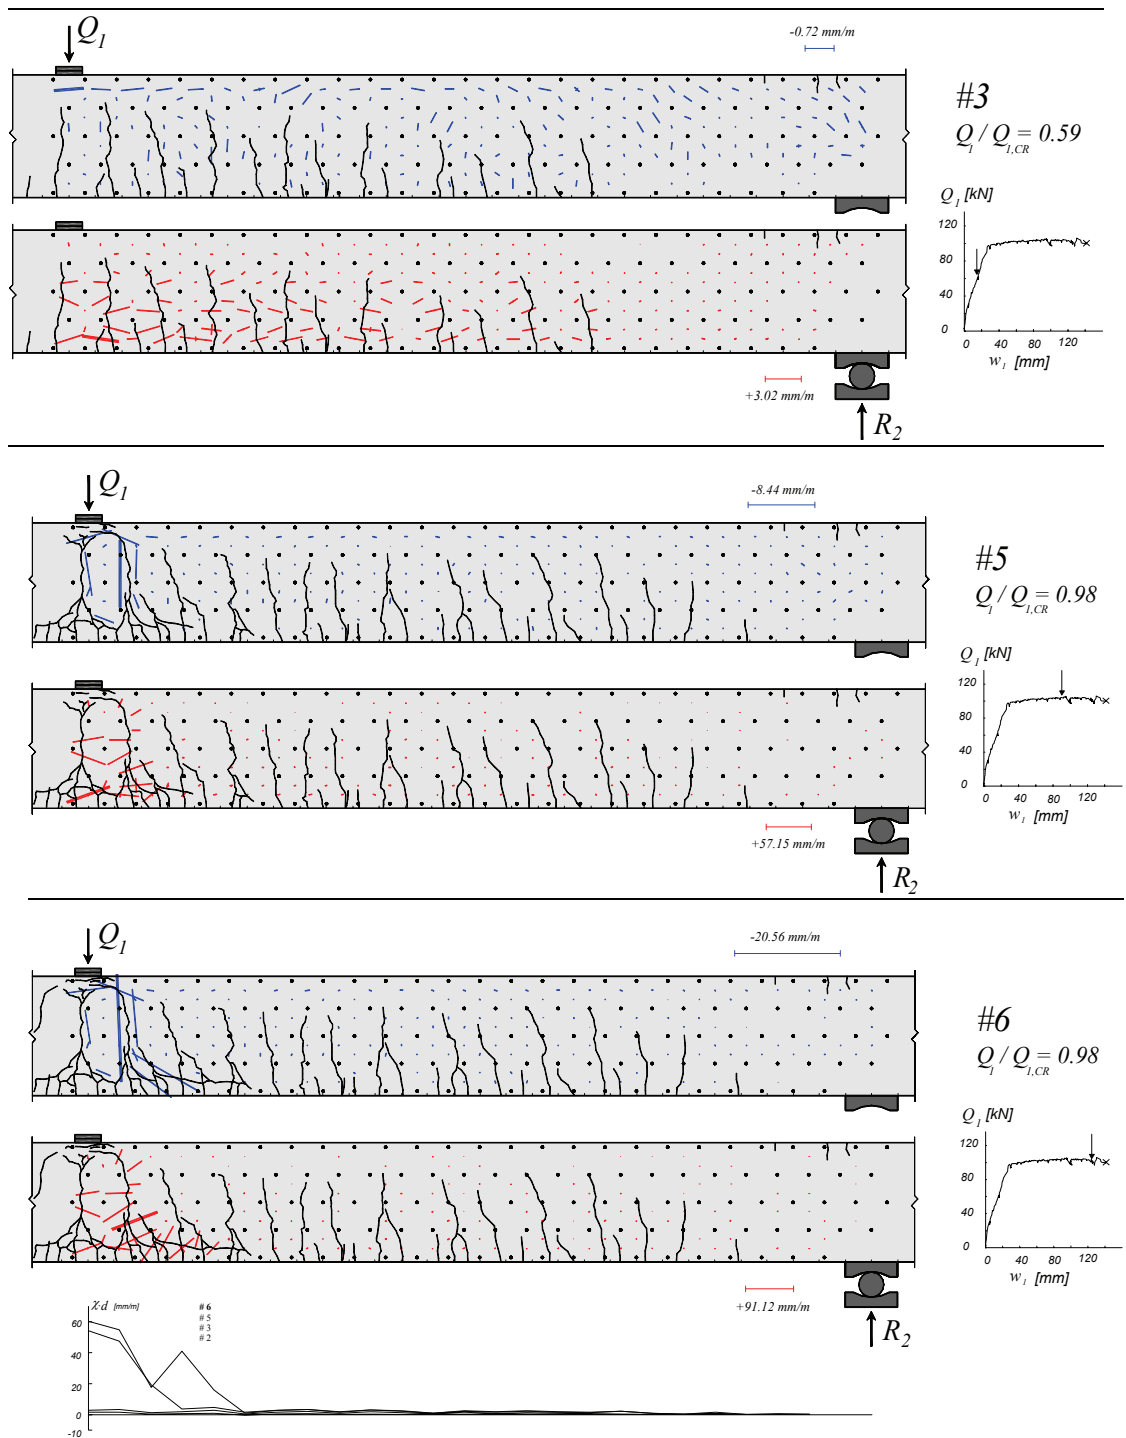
Poutre SR10: déformations principales, fissuration et courbures
